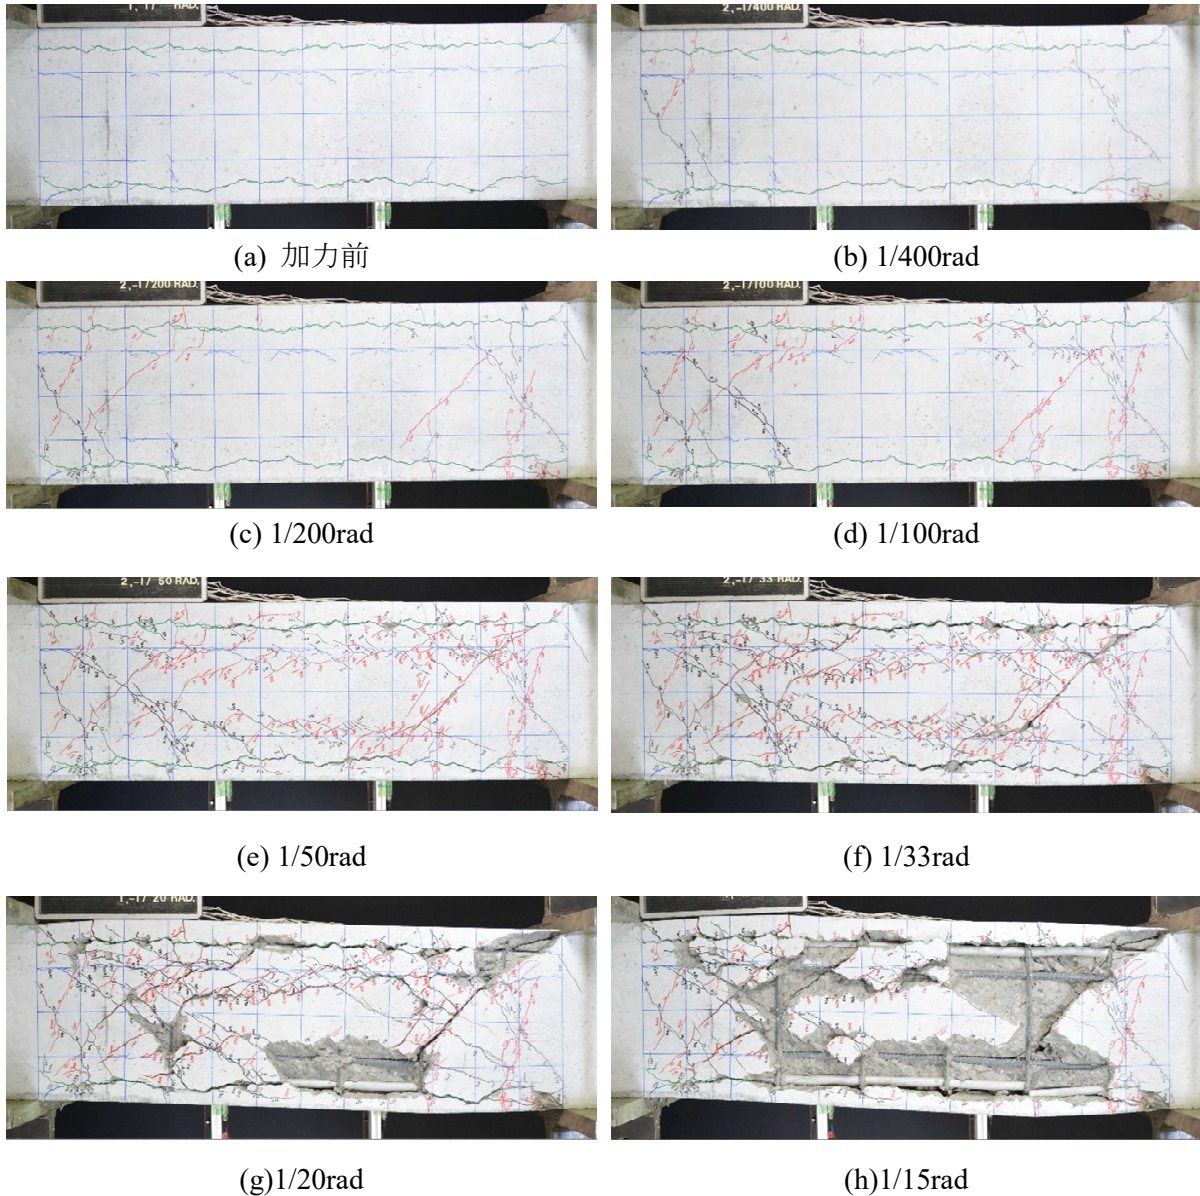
せん断破壊型試験体のひび割れ状況 (SF-Lv.3)
